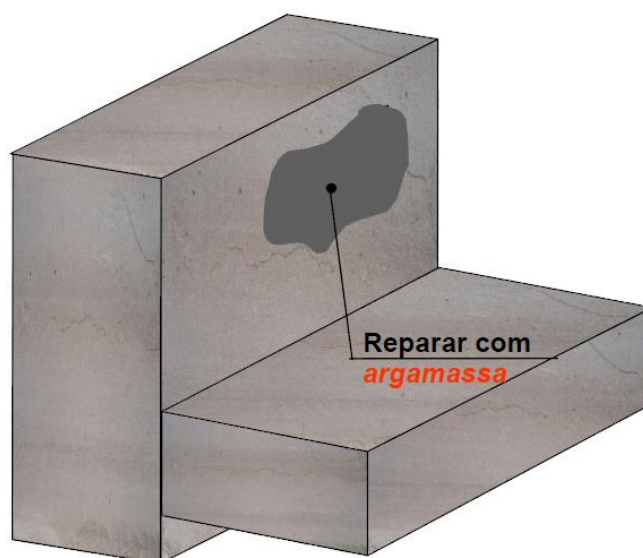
Reparações pontuais no betão com argamassa (Ecofirma, 2010).
